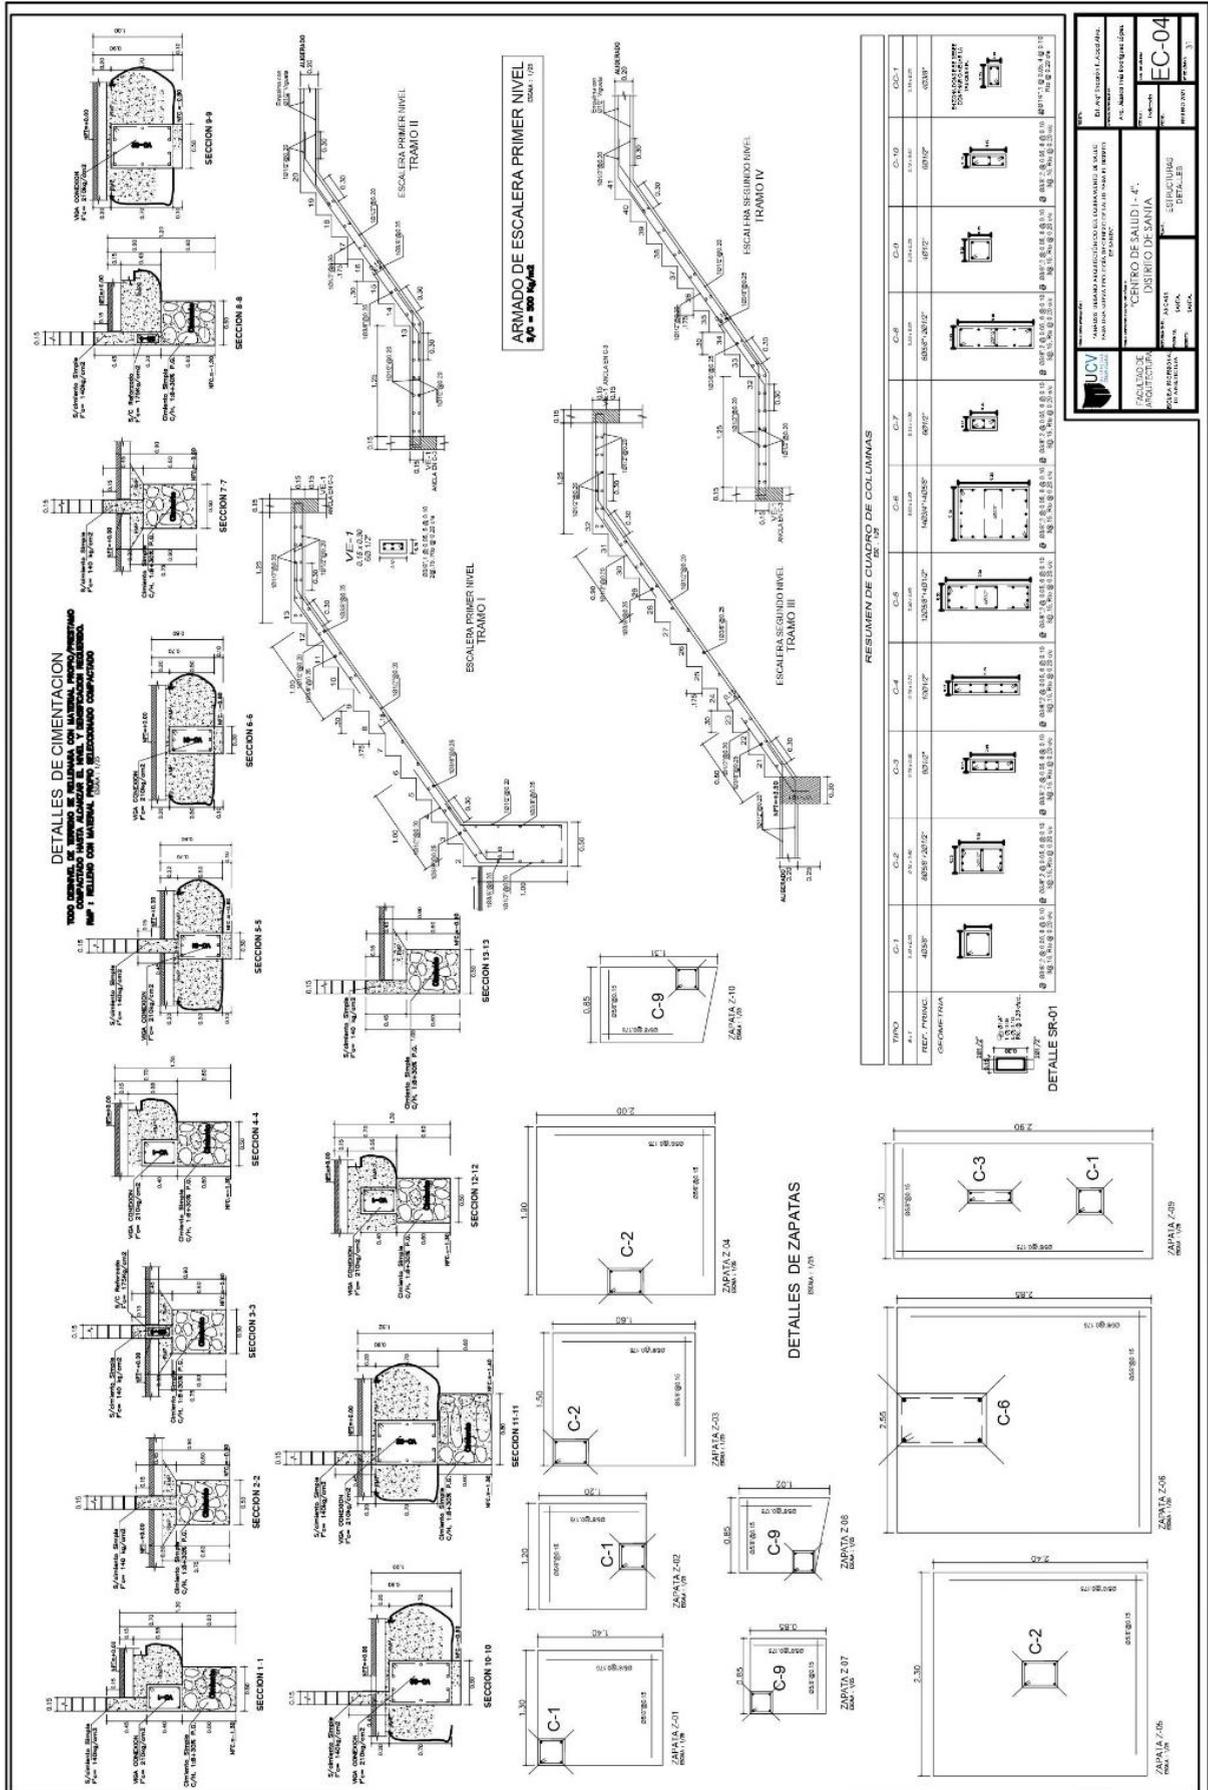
PLANO DE CIMENTACIÓN SECTOR 2
